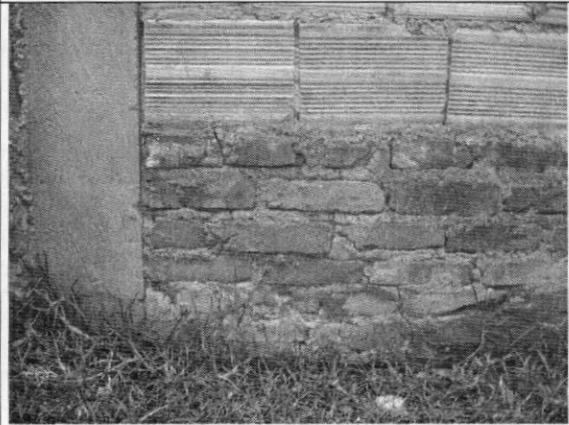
Agrietamiento en el muro de mampostería externo
